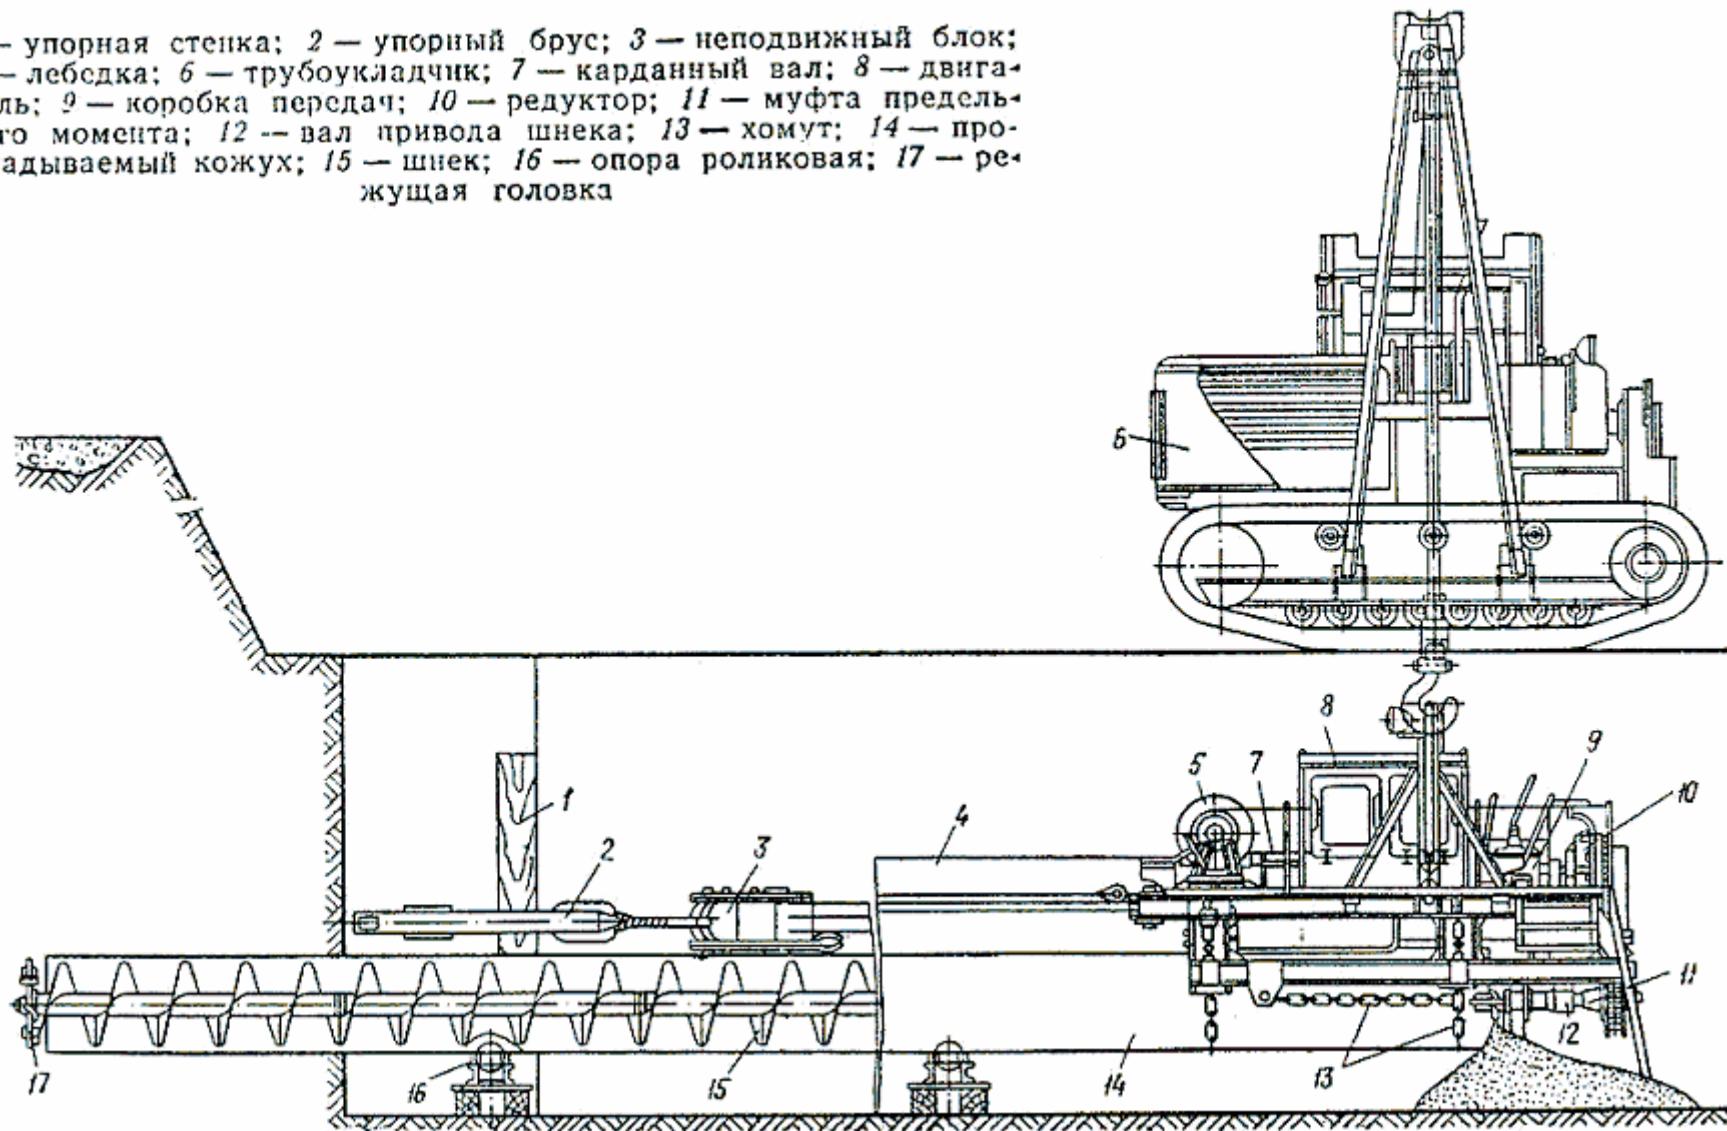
Схема установки УГБ - 1621 смонтированной в рабочем котловане
